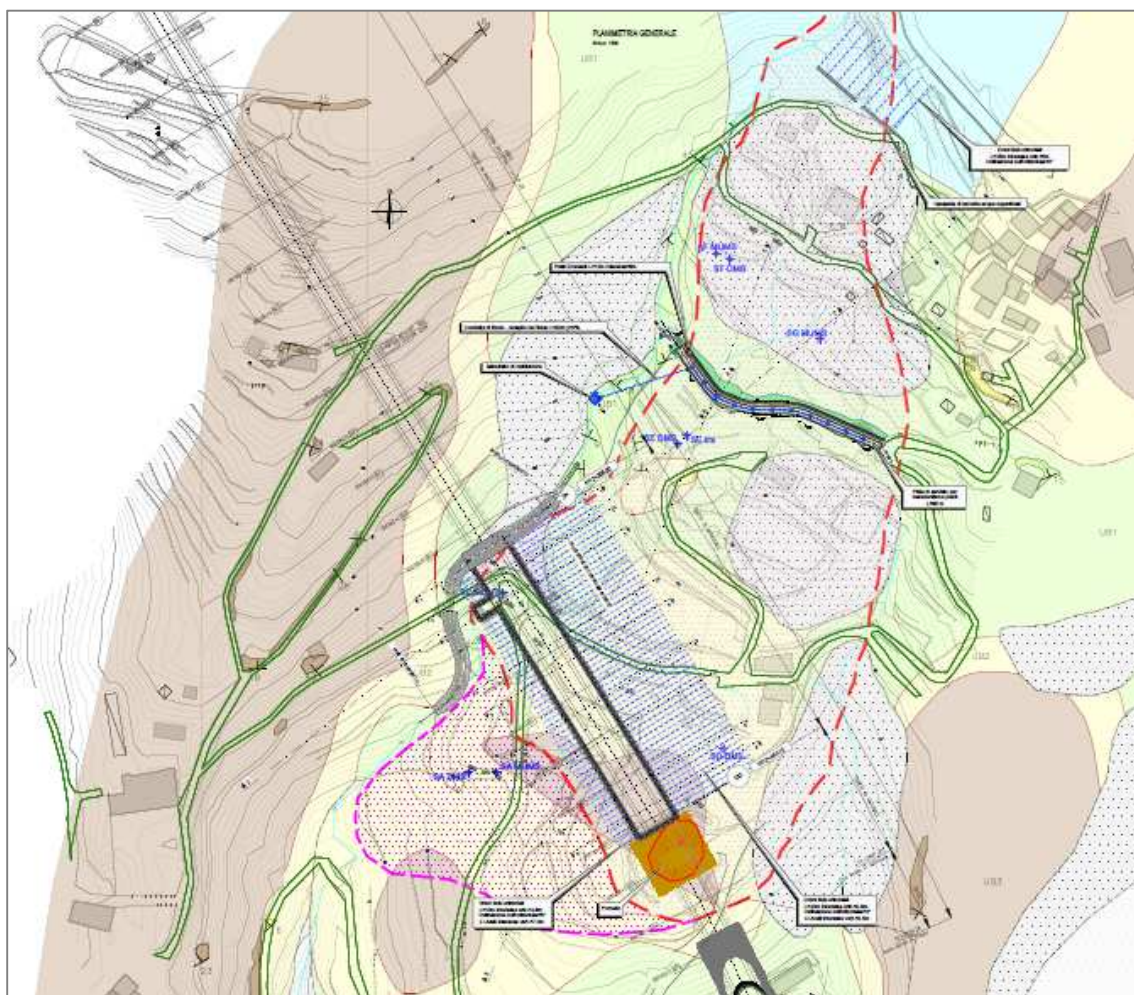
Planimetria degli interventi di drenaggio sul versante di Carozzo
